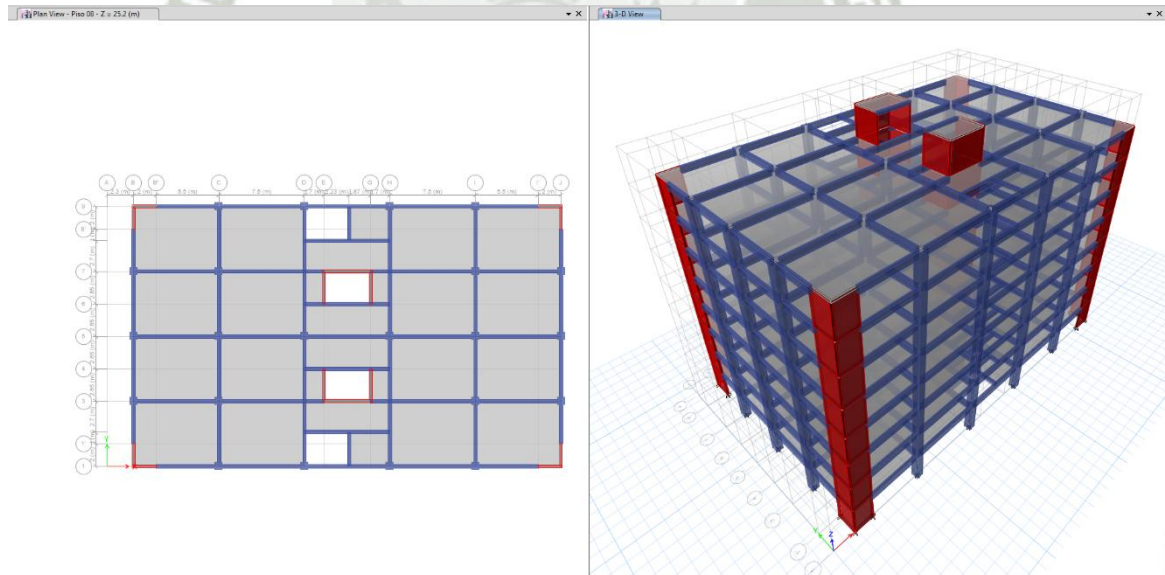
Pantalla de visualización de la vista de planta típica de la superestructura (izquierda) y del modelo tridimensional de la superestructura (derecha).
